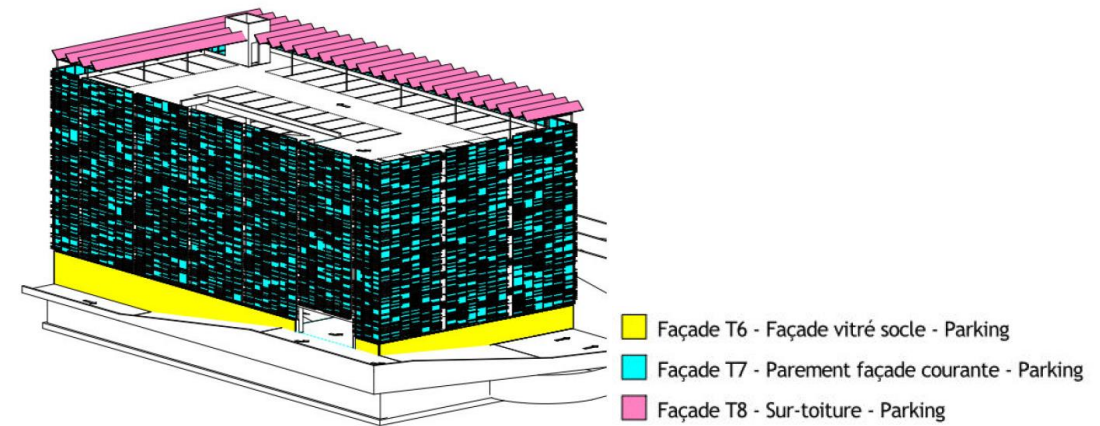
Parking en silo - traitement de la façade Sud-Ouest (AREP)
